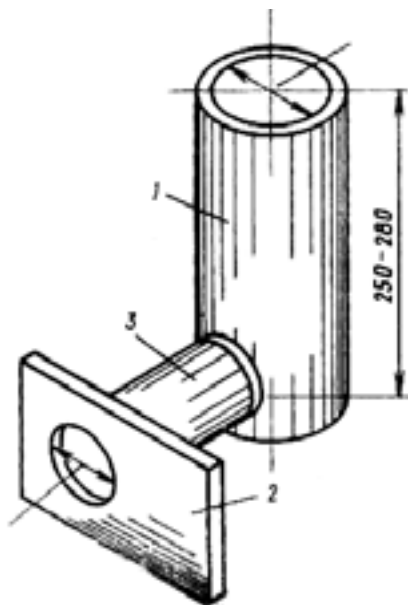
Вариант выносного аварийного выхода из железобетонных элементов: 1 – шахта из элементов смотрового колодца; 2 – плита П-2, П6А или ТК-1; 3 – лаз из колец
